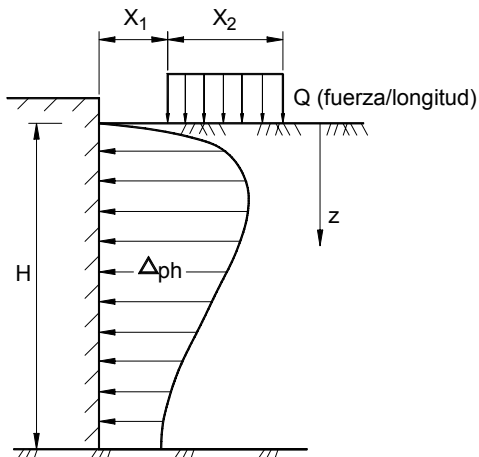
Empuje horizontal sobre un muro provocado por una carga lineal finita perpendicular al muro
